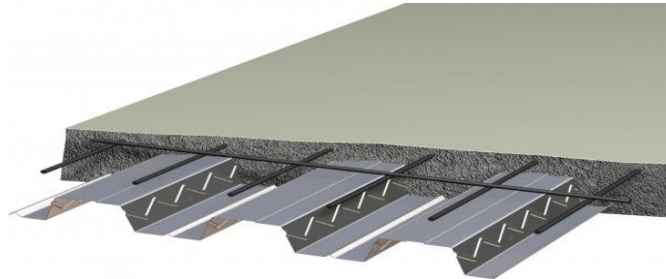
Фрагмент перекриття по профільованому настилу
